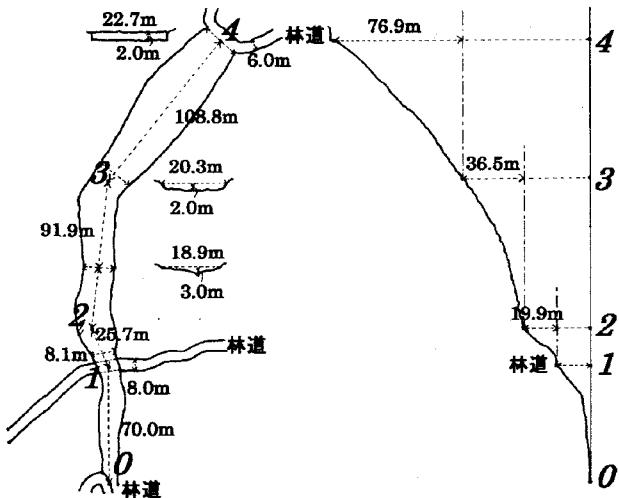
上矢作町阿寺の斜面崩壊の平面図と断面図
